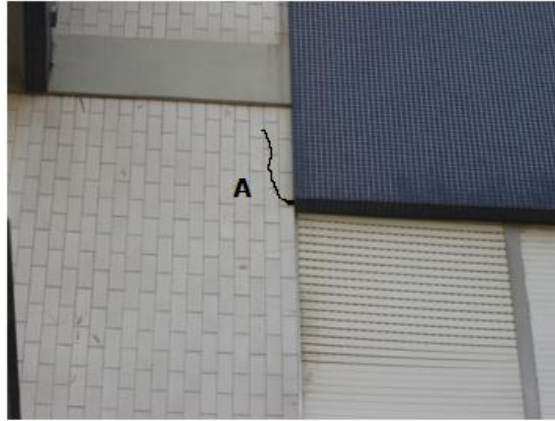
Fissuras/Fendas no canto da janela “A”
